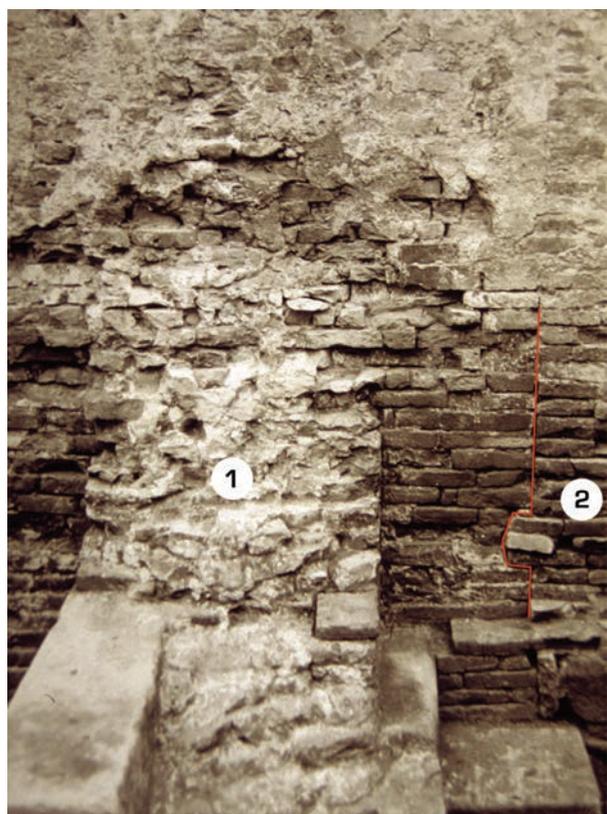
Santa Sofia: muro ovest del transetto (1) con alzato provvisto di paramenti in laterizi e interno in opera cementizia. Gli si addossa il perimetrale della navata (2).
